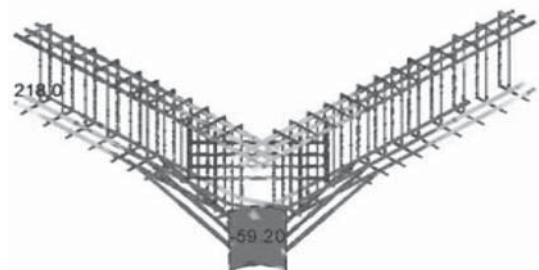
鉄筋コンクリート全体の構造解析⁸⁾
